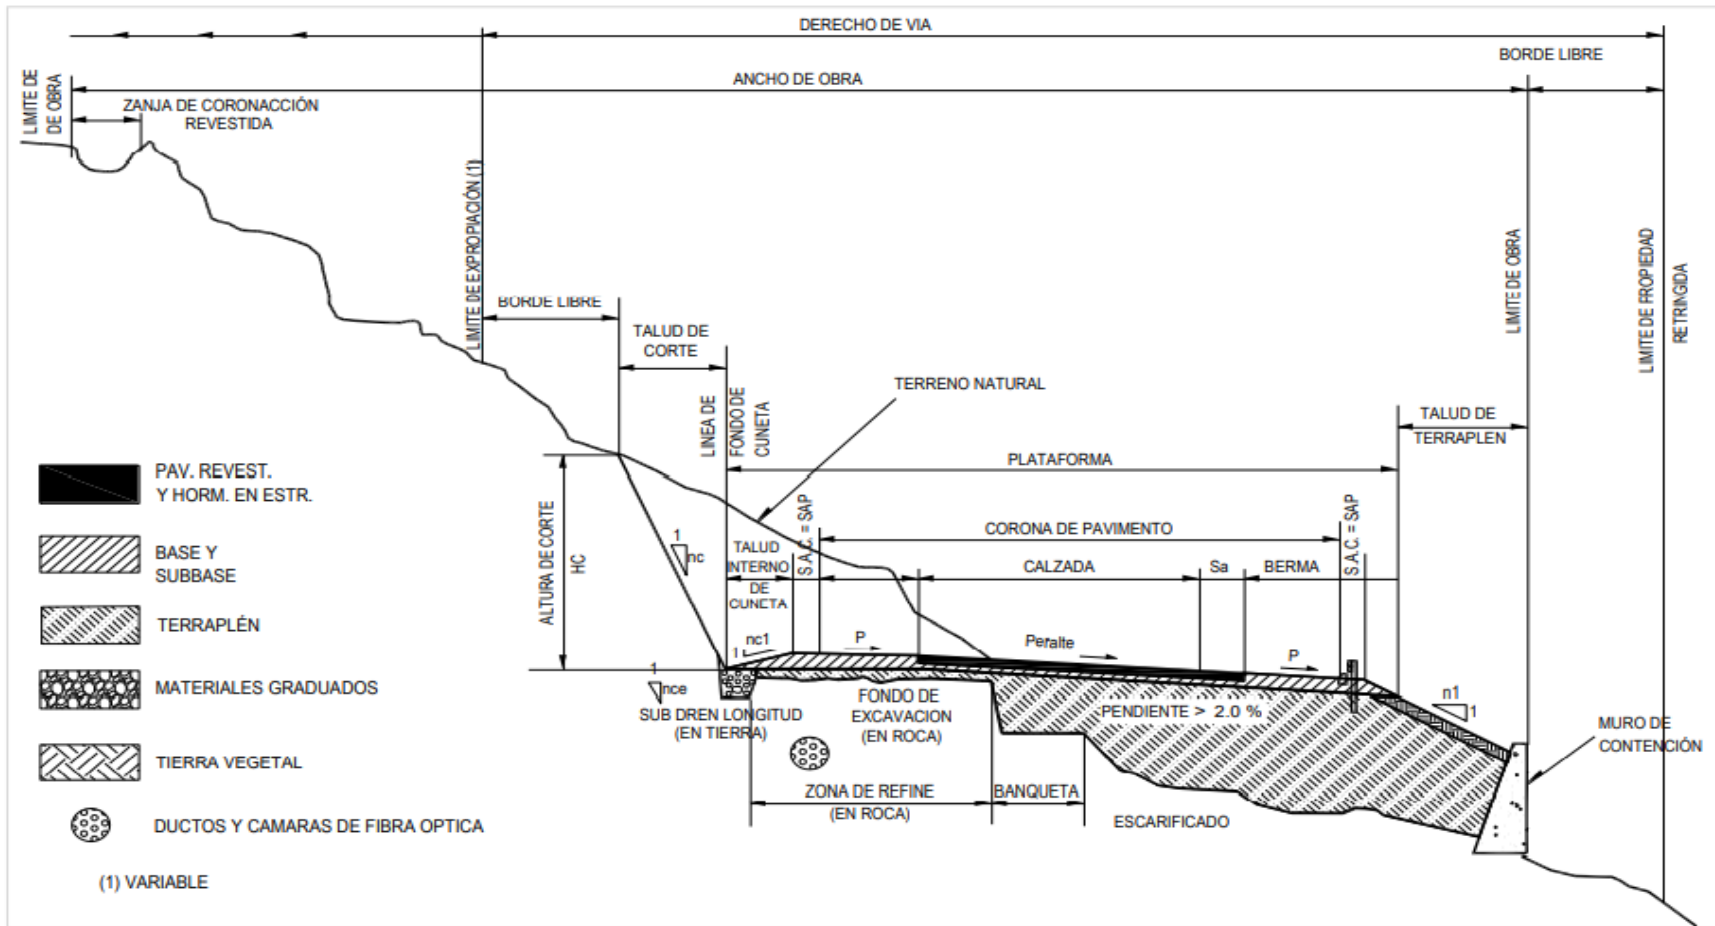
Sección transversal tipo medio ladera para una autopista en tangente.
